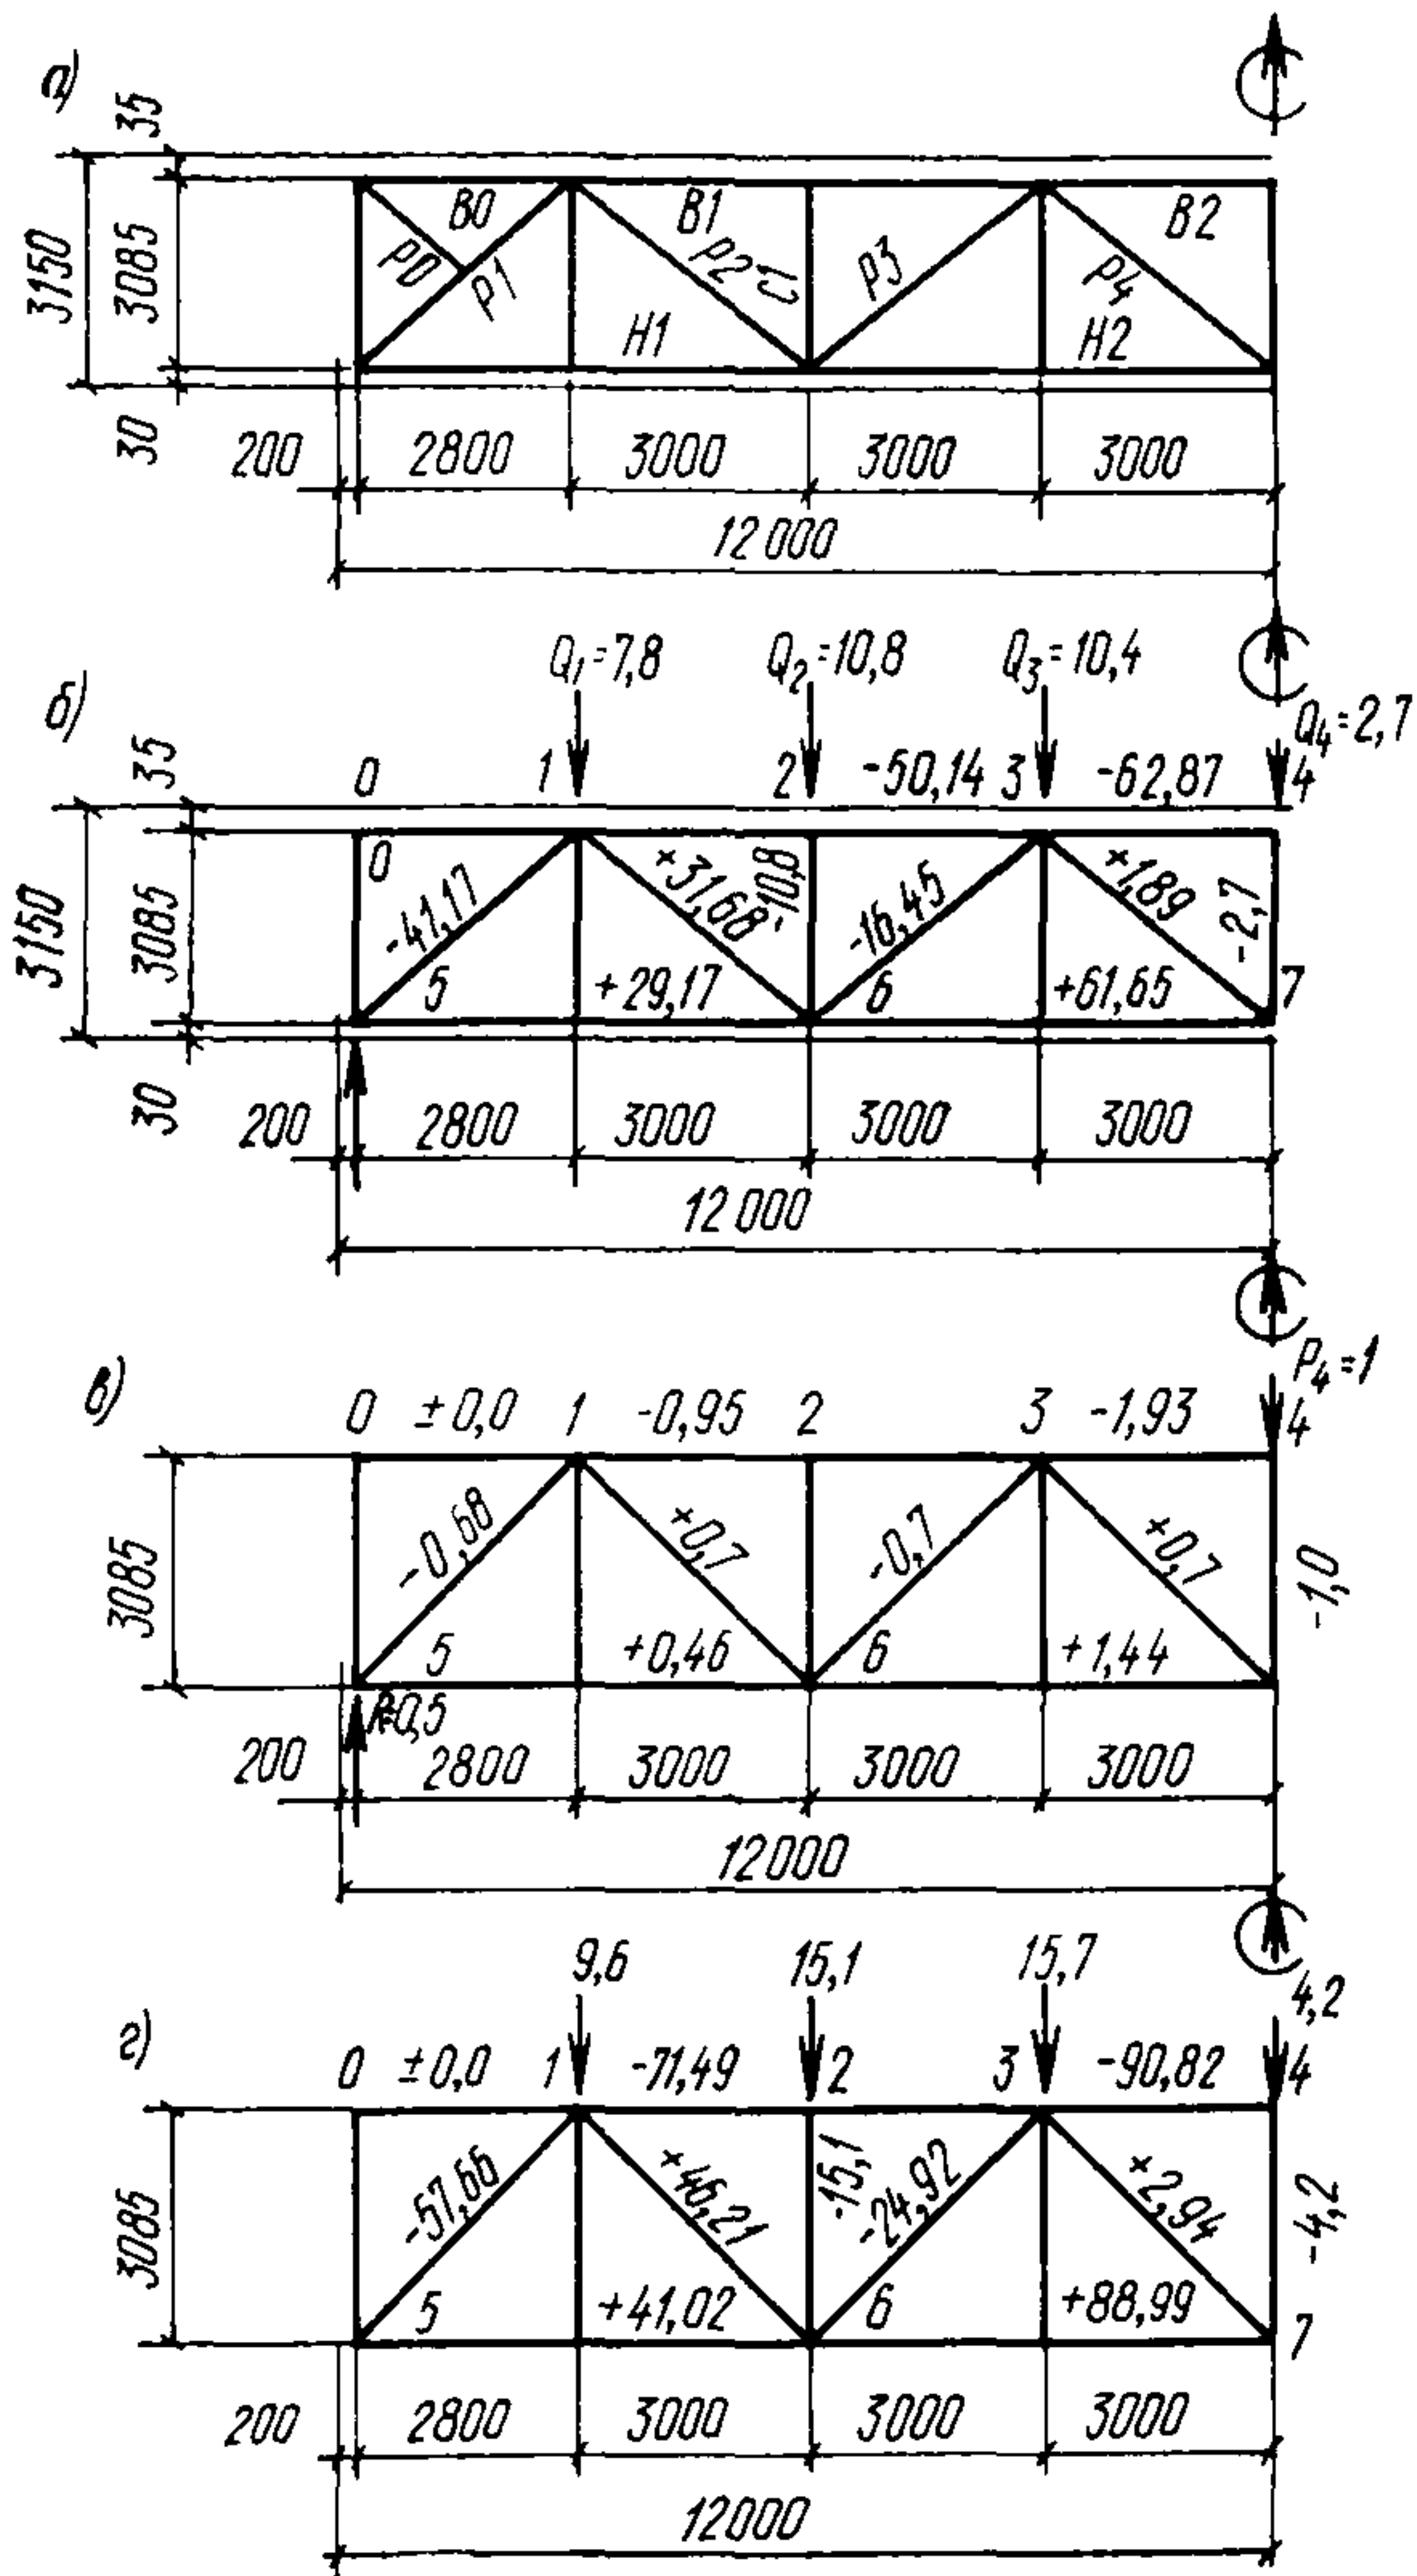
Схемы к расчету стропильной фермы с учетом вертикальной сейсмической нагрузки
